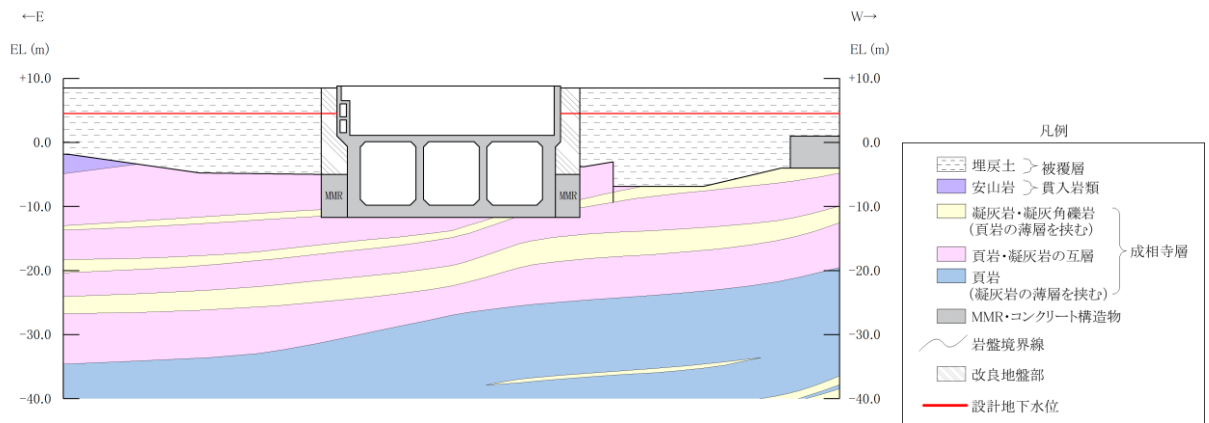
取水槽 地震時荷重算出断面図 (B-B 断面)
